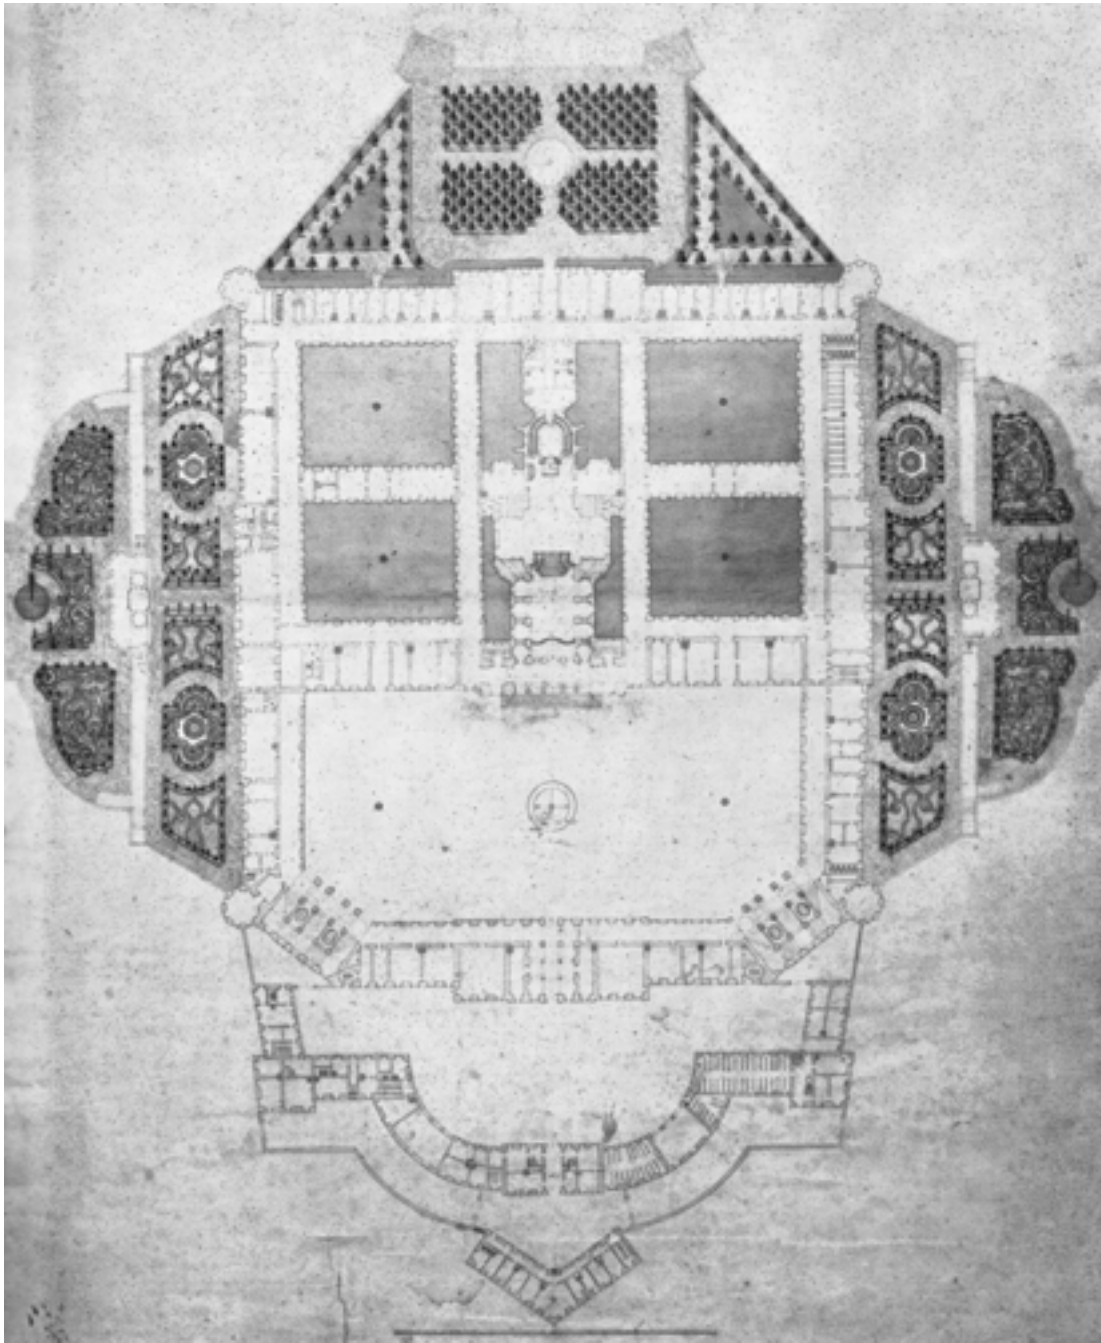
Das Stift Göttweig. Grundriss der Gesamtanlage.
